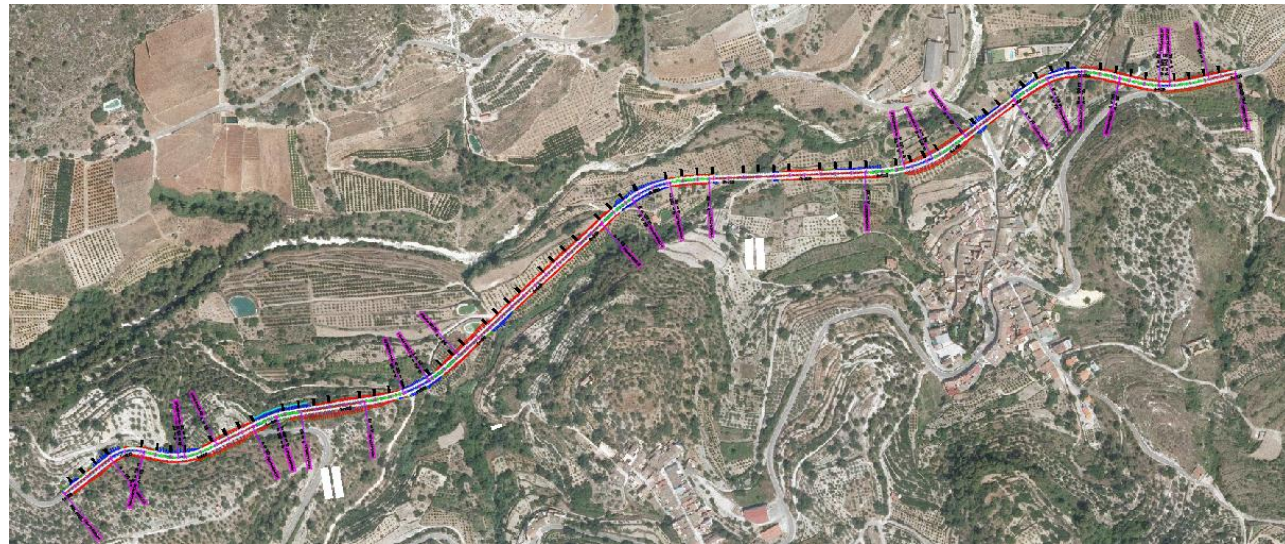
Trazado final en planta. Fuente: Elaboración propia.
